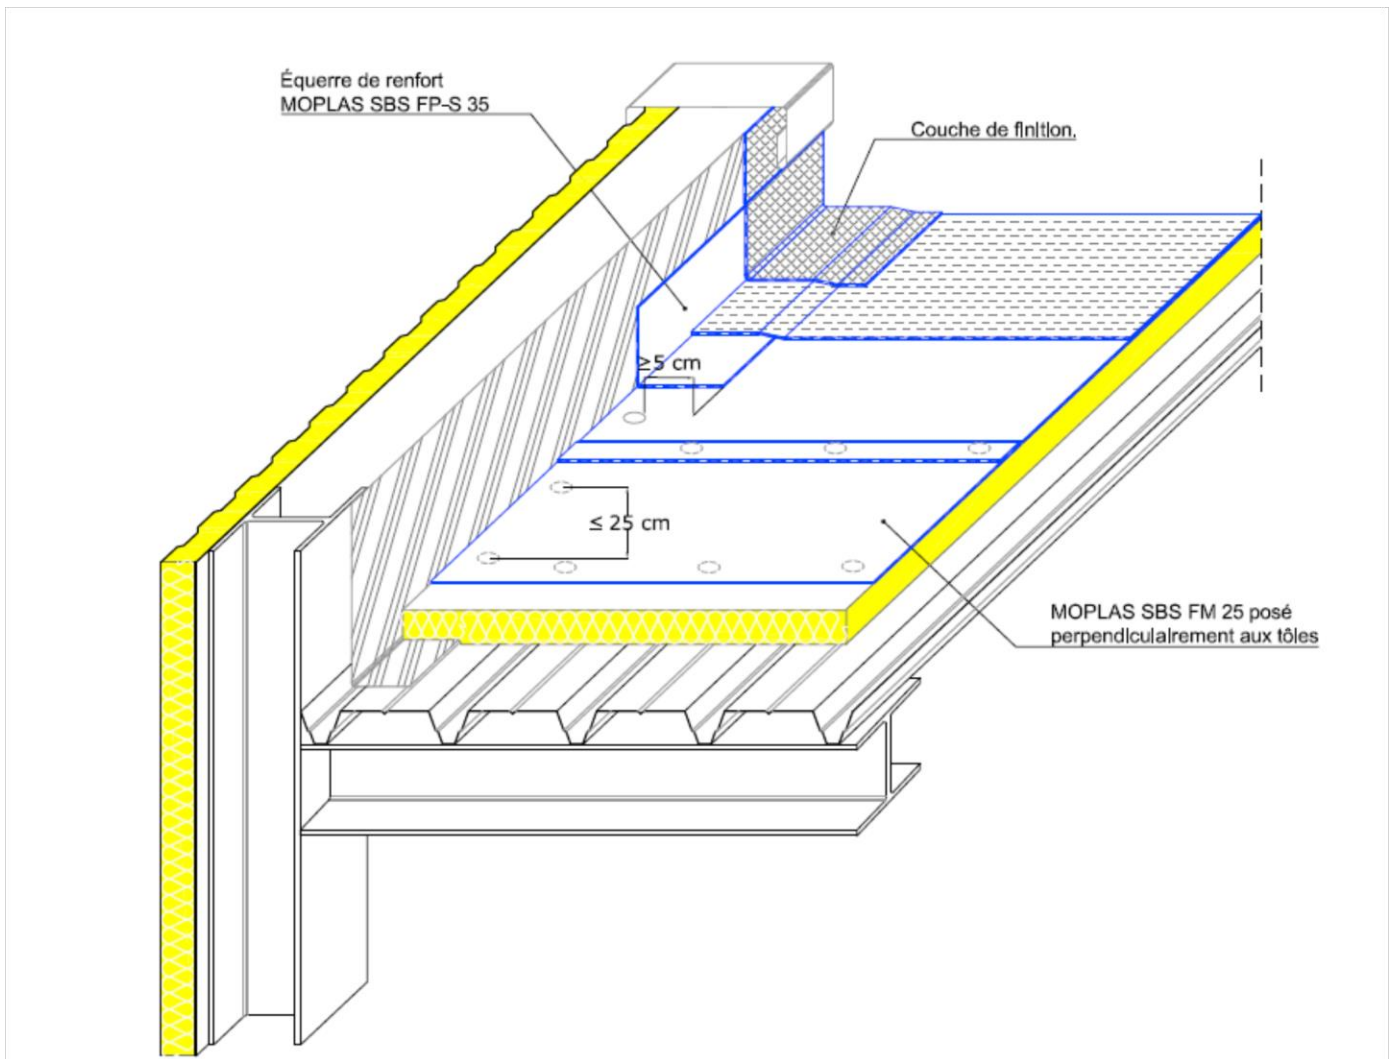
Coupe sur relevé, Schéma de principe sans échelle, cote en cm
